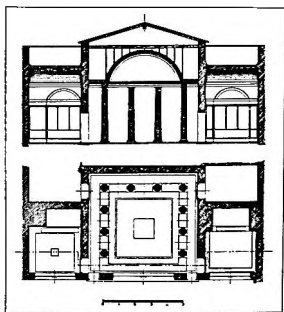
Idem. Casa do Centenário (IX,8,6) a) planimetria geral; b) reconstrução do ambiente 43 (Mau, 1900).
